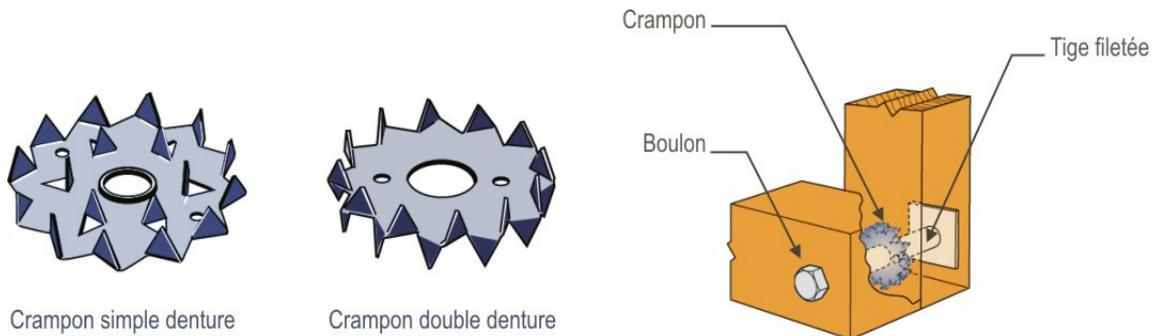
Crampon d'assemblage poutres et poteaux primaires - ©Simpson Strong Tie
